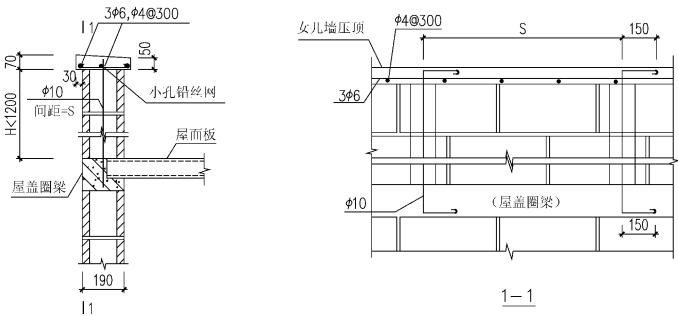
栏板及女儿墙拉结示意图 (单位:mm)
